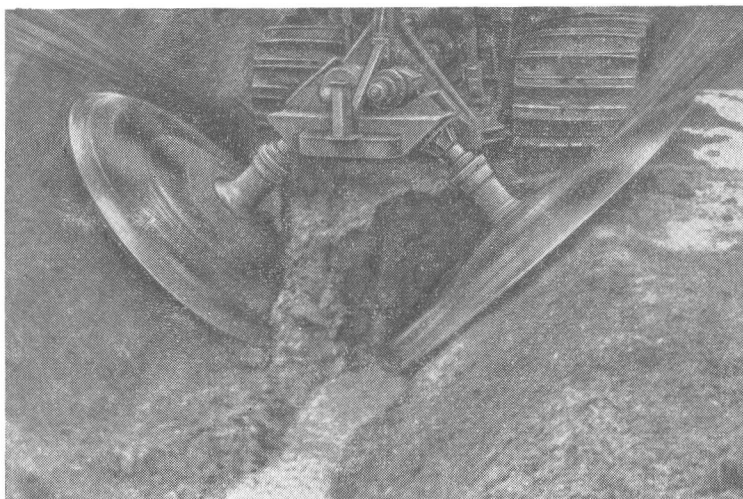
Каналокопатель КФН-1200 без двухотвального клина
